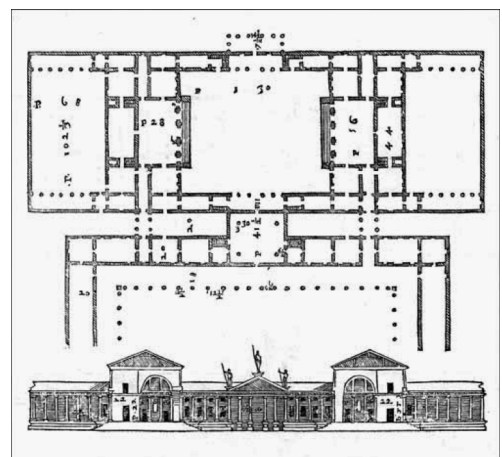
Plano y alzado de la Villa Thiene (Palladio, Cuatro libros sobre arquitectura, 1570)
